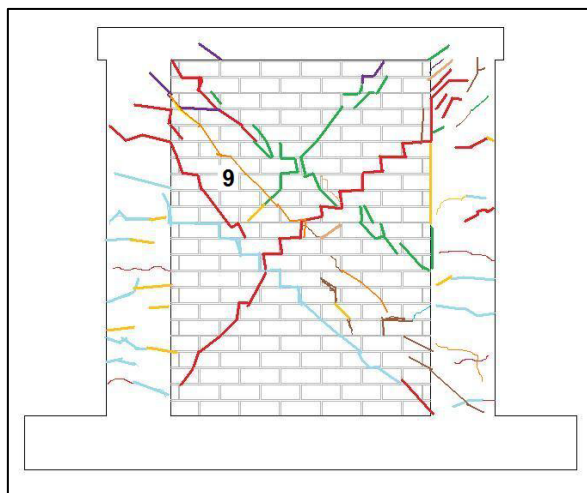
Fisura diagonal producida en la fase 9.
